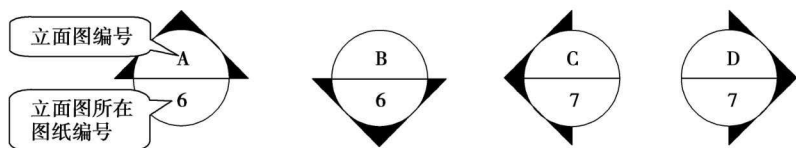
立面图与平面图不在同一张图纸上时的内视符号
